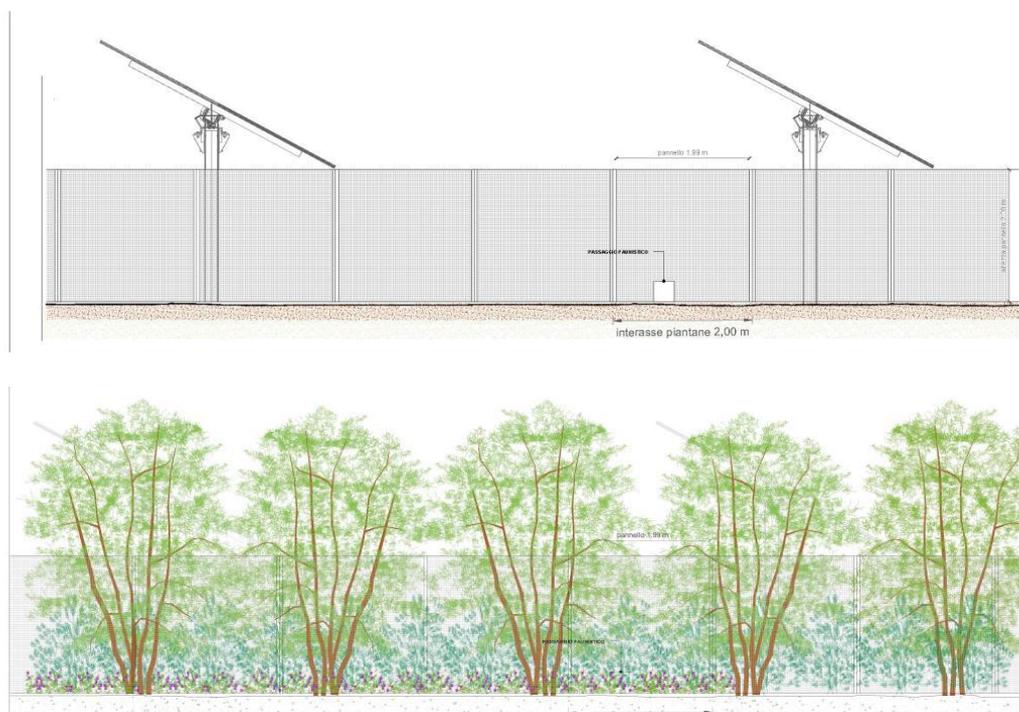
Prospetto recinzione perimetrale senza e con mitigazione
